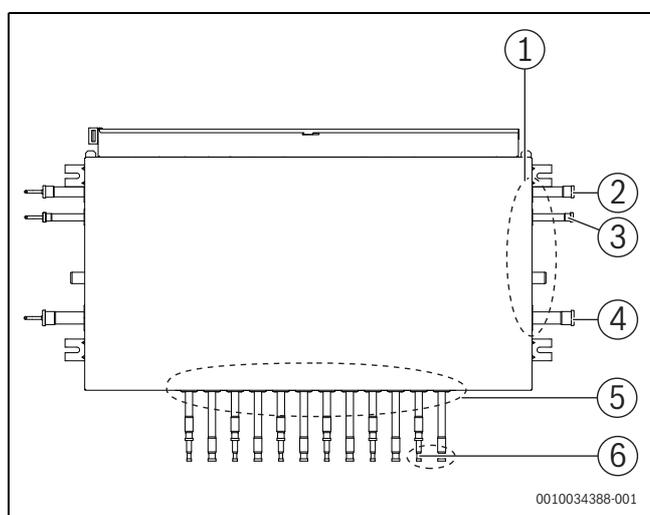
Сварка медных труб—групповой Sbox
